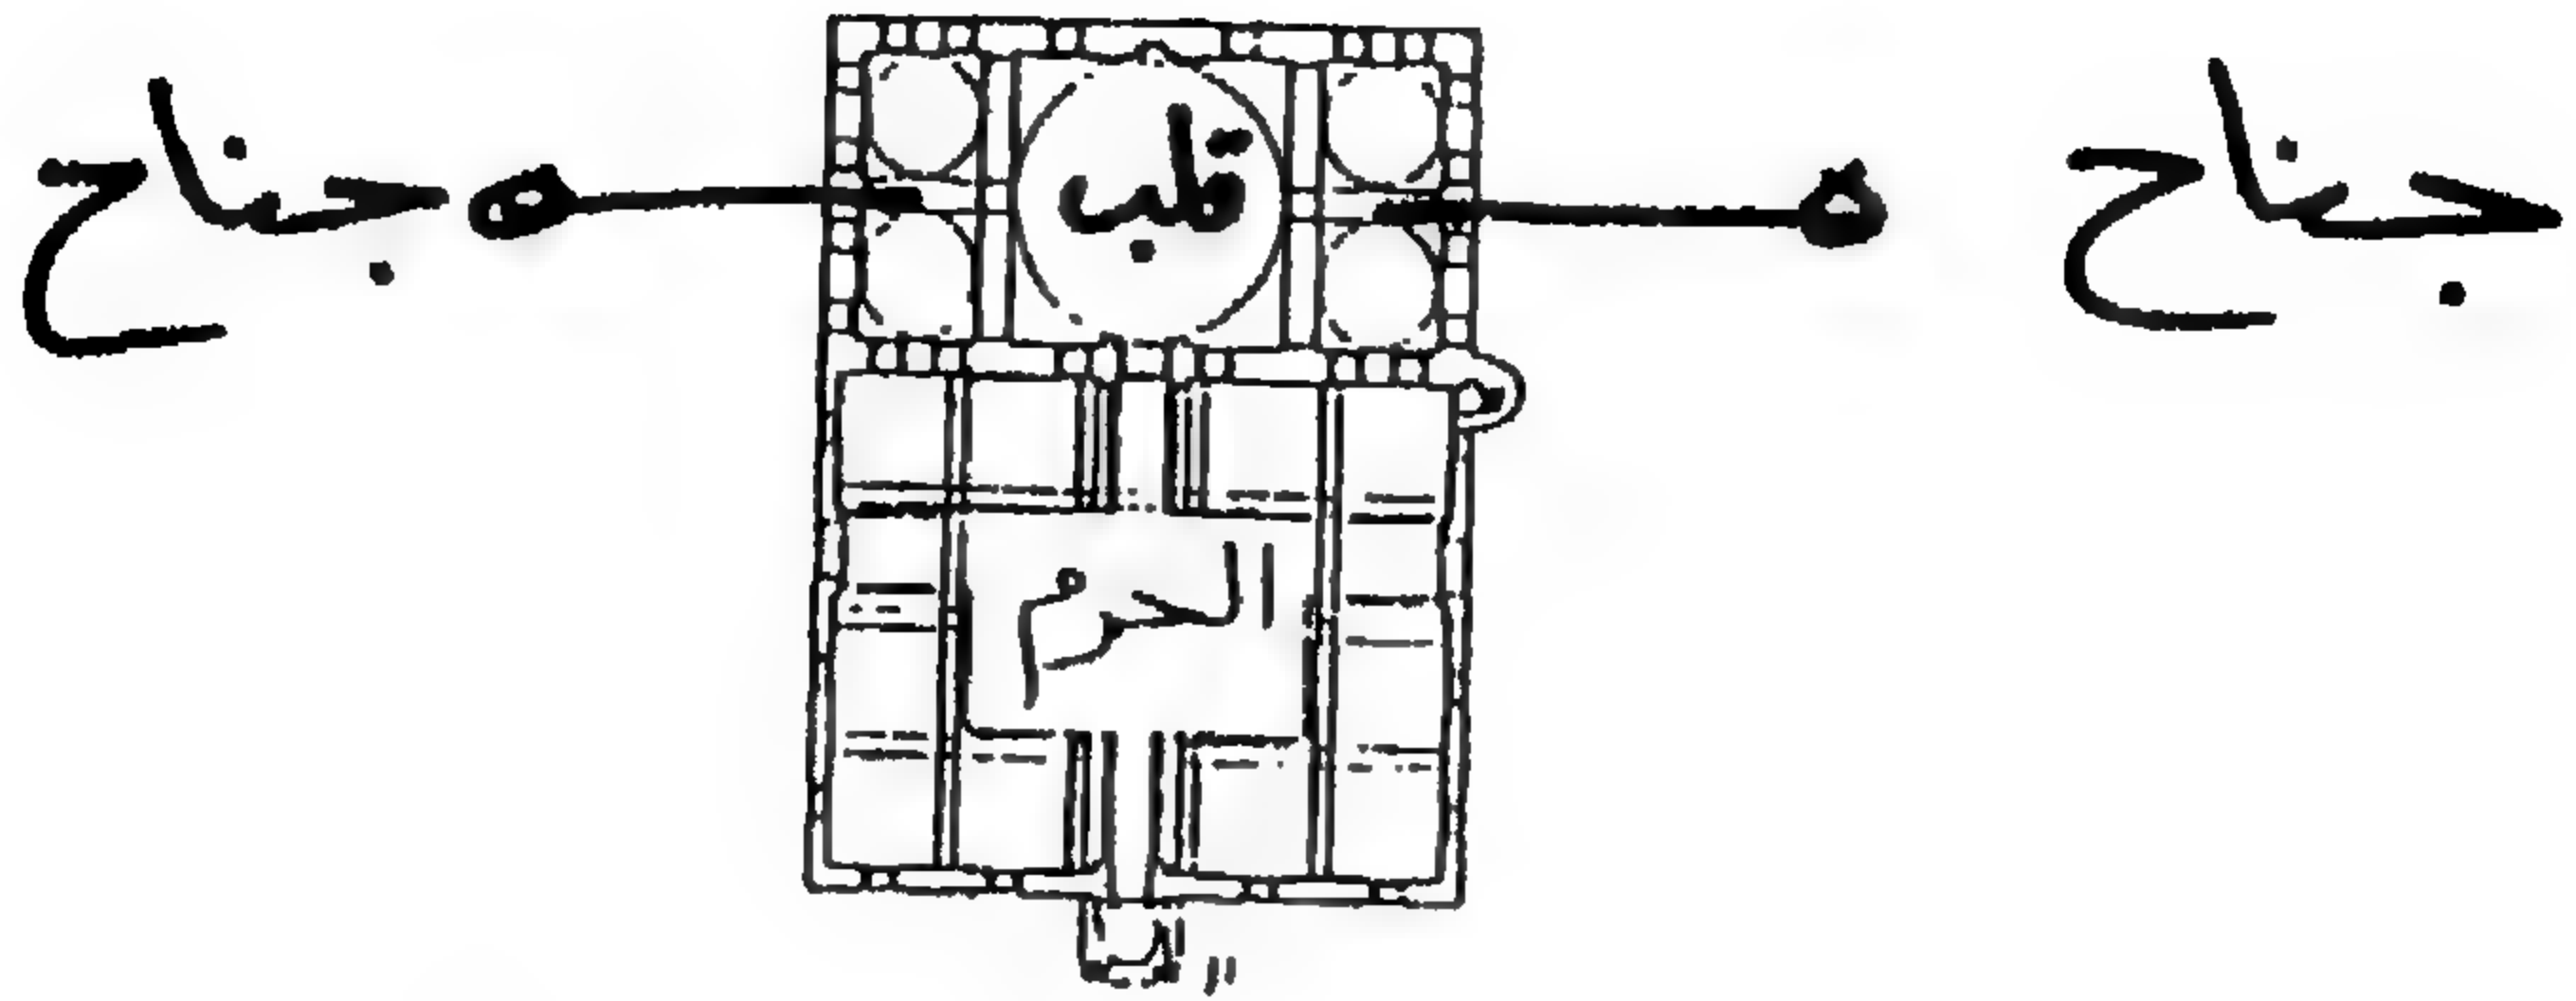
مسقط أفقي لجامع سويون من زاده بالقاهرة
